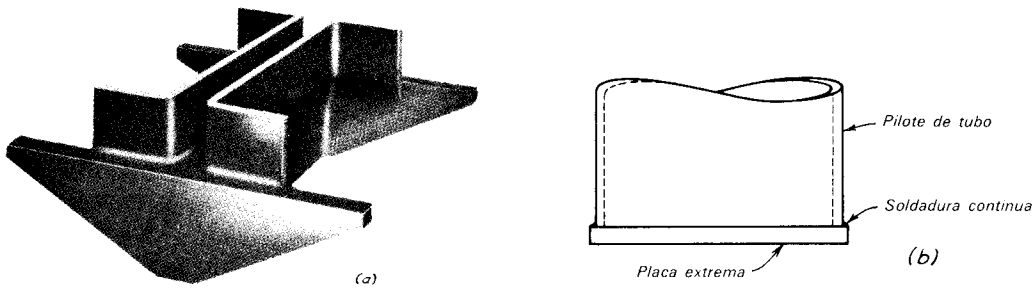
a) Refuerzo para la punta de pilote H (Associated Pile and Fitting Corp.).
